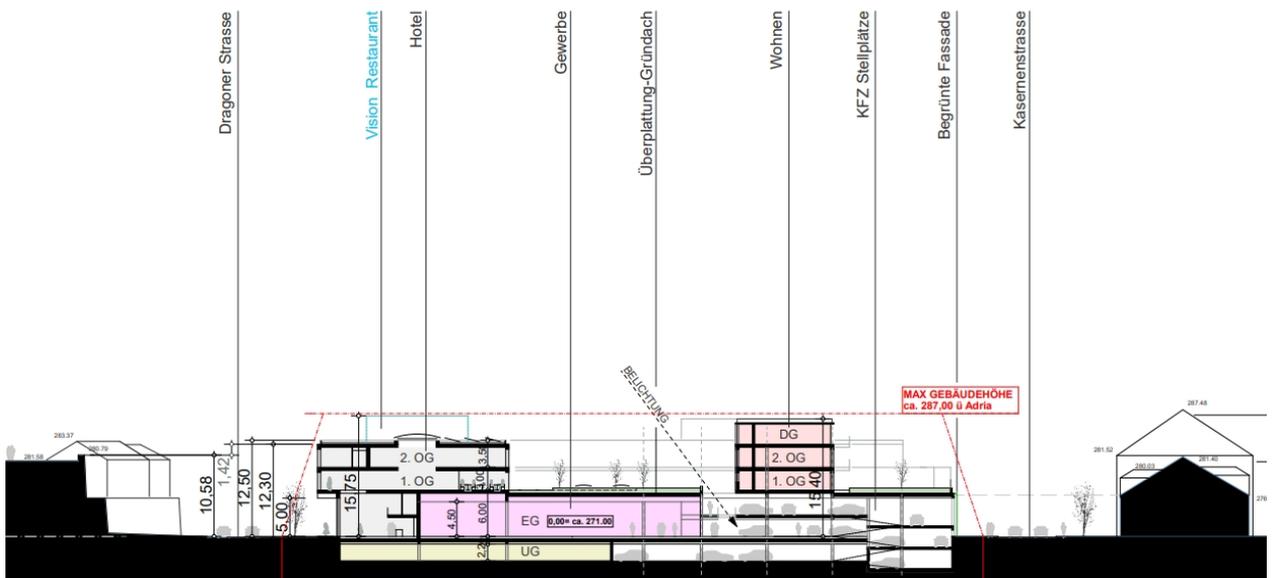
Schnitt der geplanten Gebäude mit Darstellung der Geschoße und Bezugshöhe, Neuhauser, 26.07.2022
